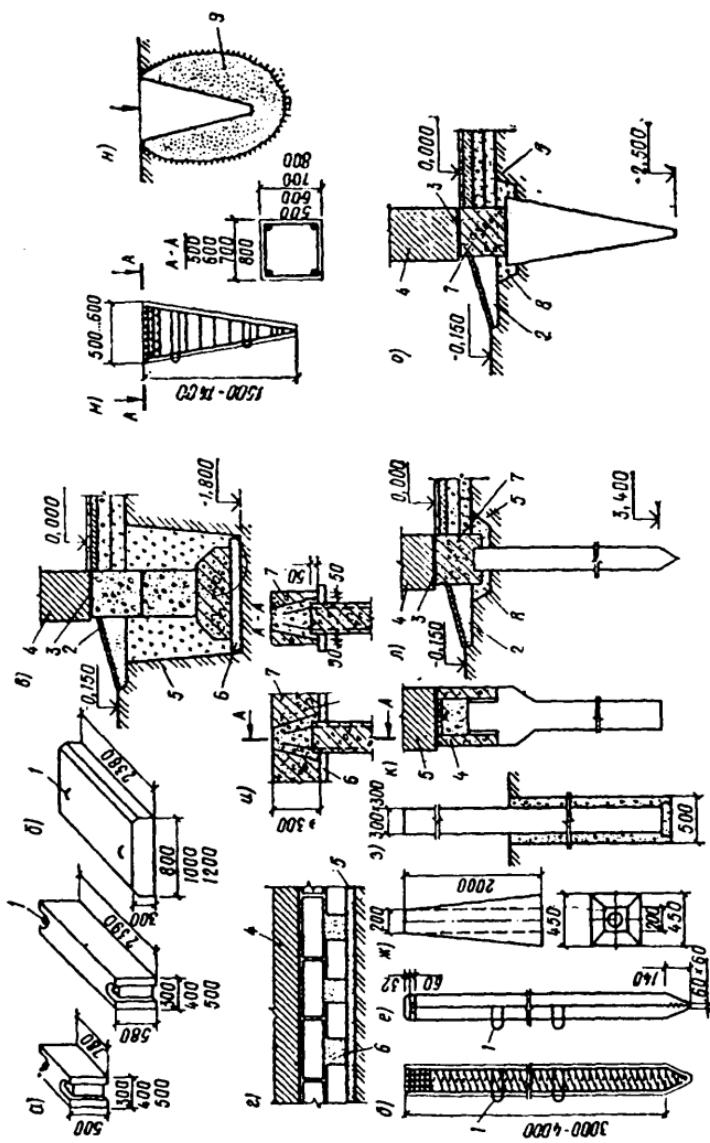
Конструкции сборных ленточных и свайных фундаментов:
